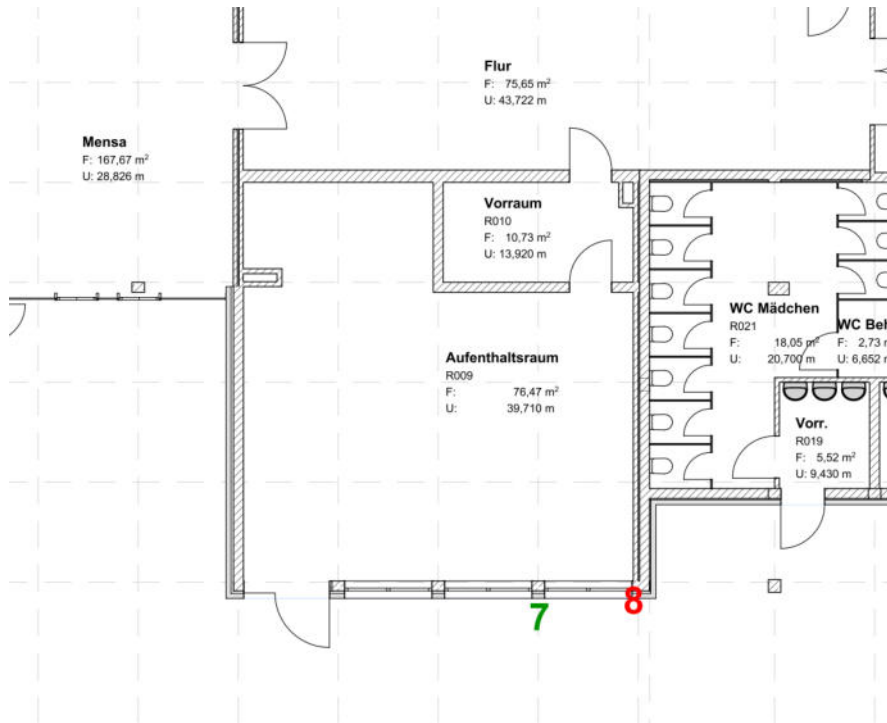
Grundrissausschnitt Ebene 1 (grün = ohne Befund, rot = Befund)
